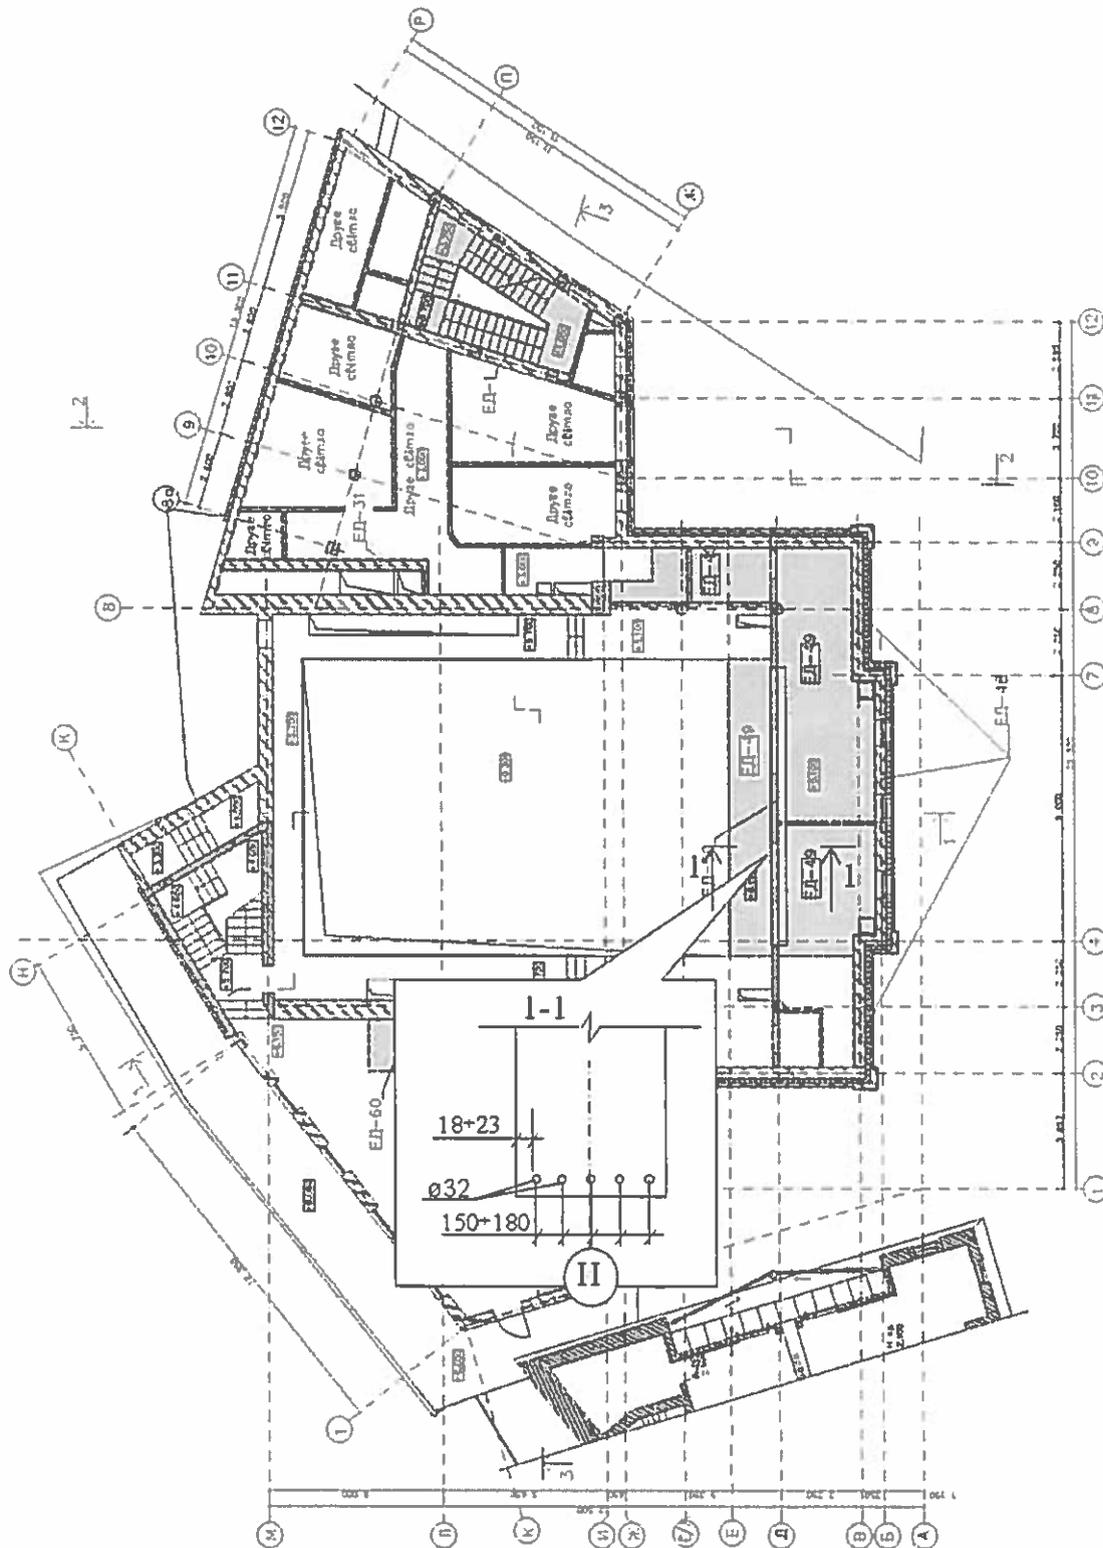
План будівлі на відмітці +5.400 з місцями визначення параметрів армування балки
